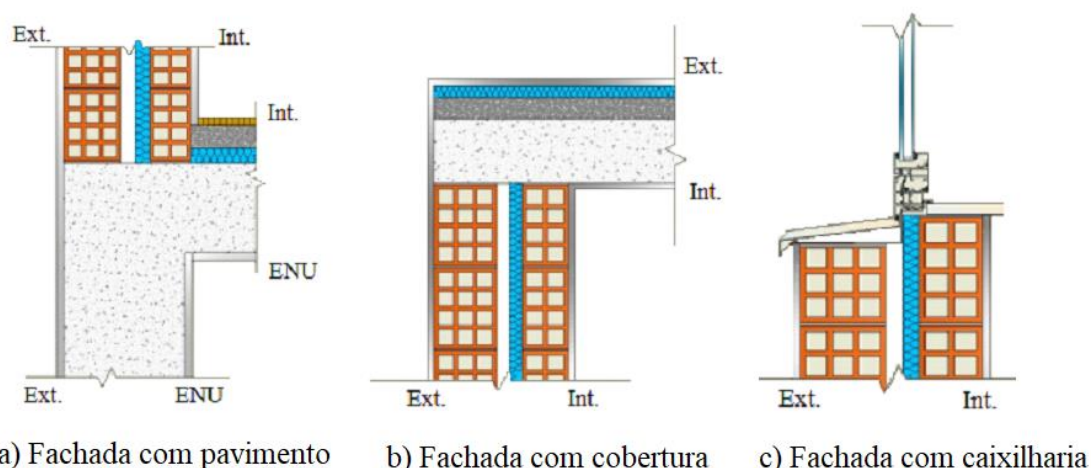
Pormenor construtivo de ligações (adaptado ITeCons, 2017).
